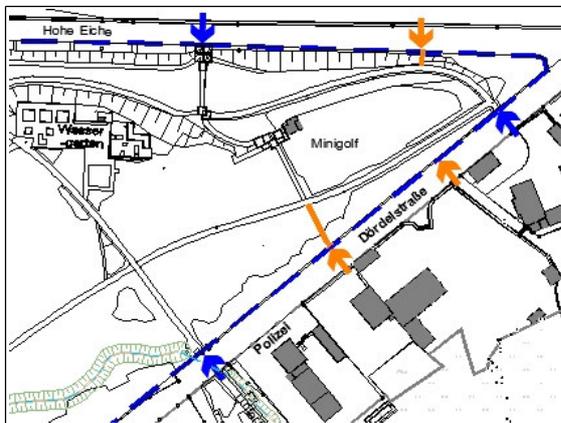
Lageplan für neue Parkeingänge an der Dördelstraße und Hohen Eiche Nord
